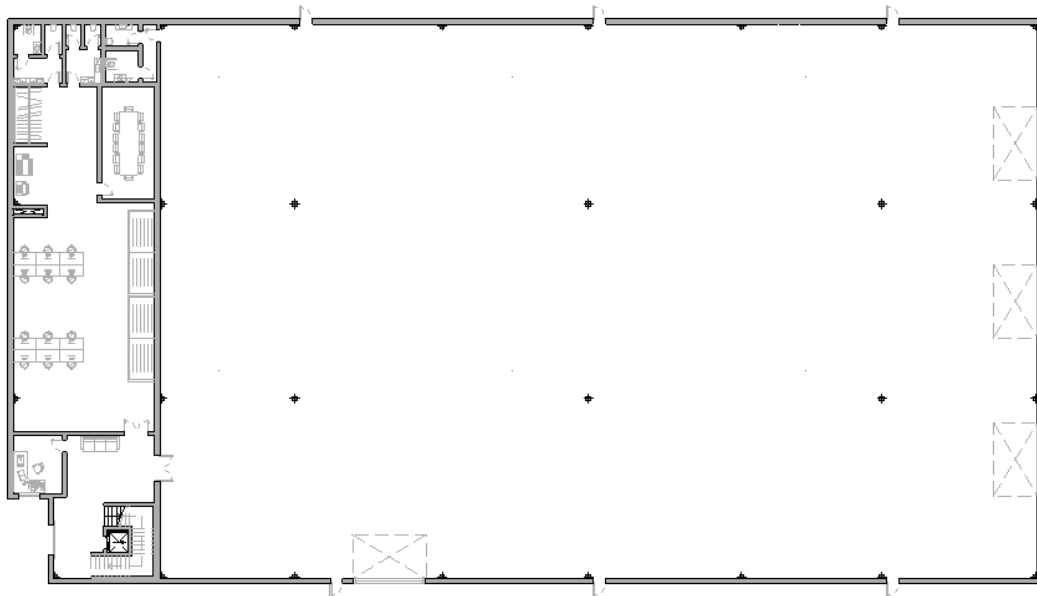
Distribució inicial planta baixa. (Font pròpia)
